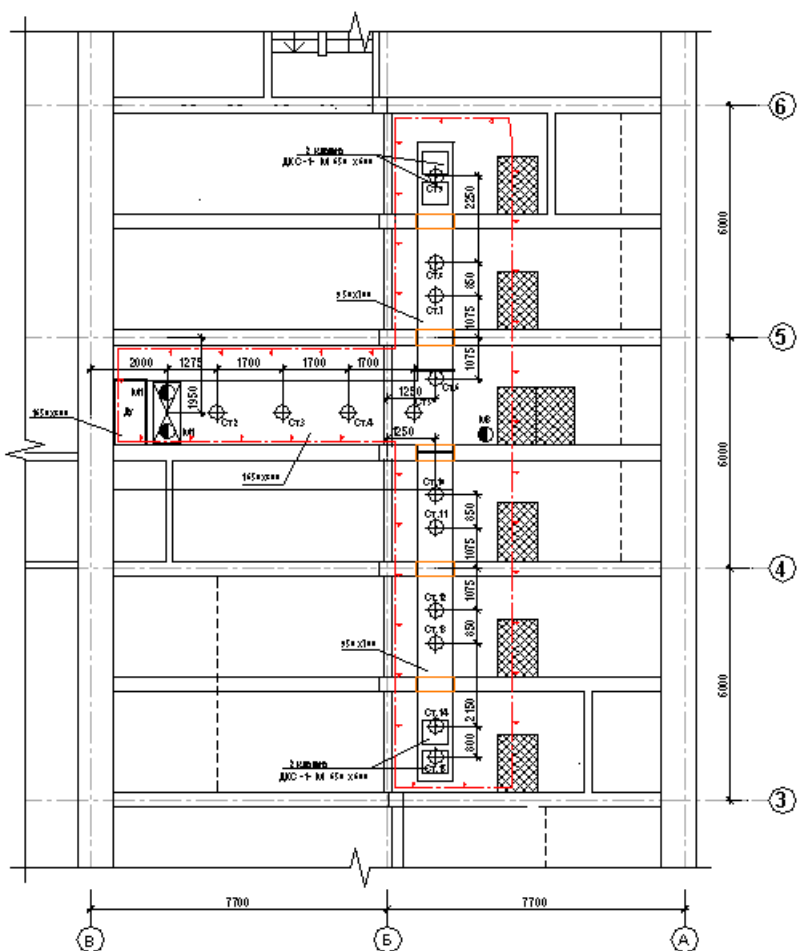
Схема монтажа системы дымоудаления. М 1:100
